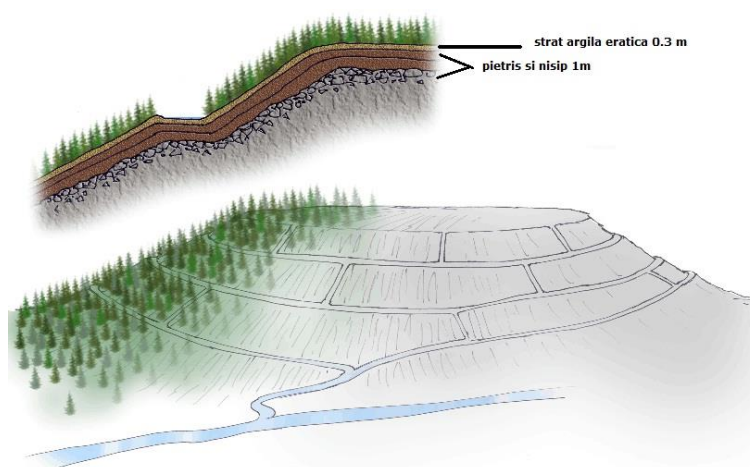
Structură strat protector al unei halde de piatră reziduală
